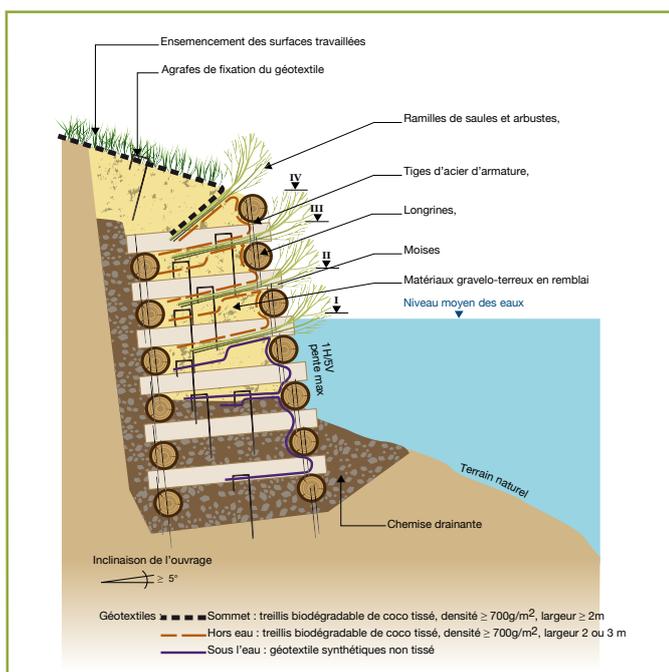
Schéma en coupe d'un caisson végétalisé en pied de berge
